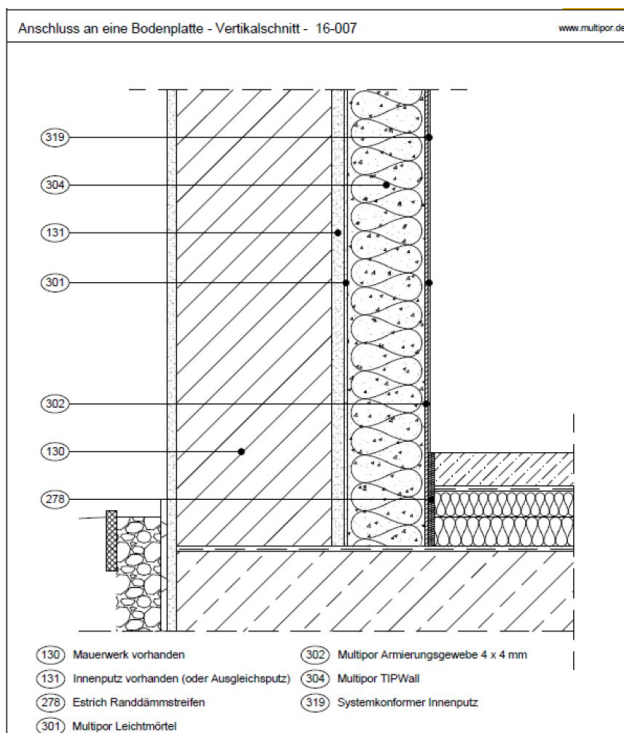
Detail des Bauteils | © Stadt Elmshorn
